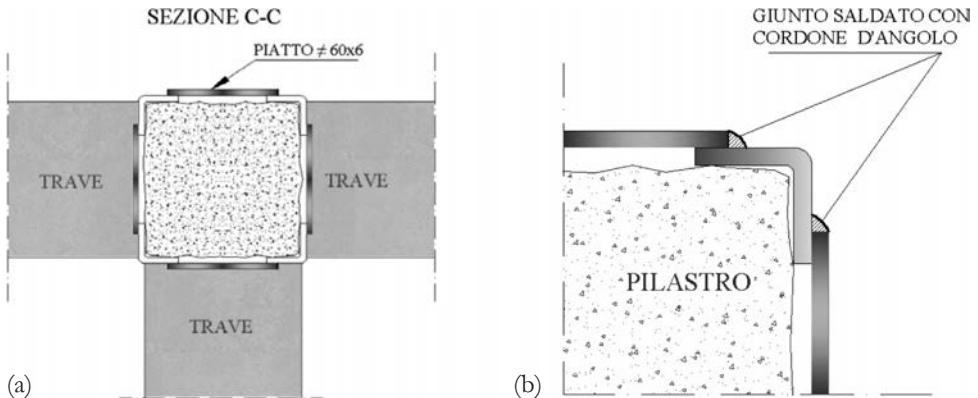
Viste in sezione: (a) sezione C-C (b) particolare della saldatura con cordone d'angolo.
